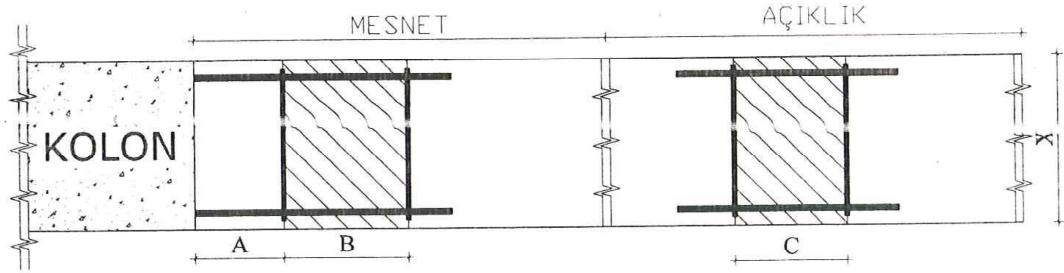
Paspayı sıyrılarak yapılan kiriş donatı tespit tutanağı-yapı elemanı TT-N1-KP1.
